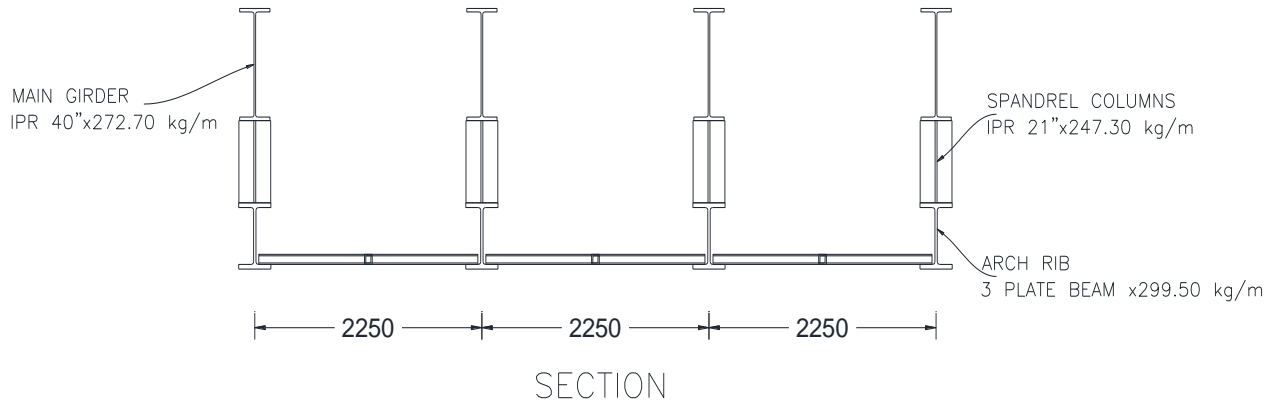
Elevación transversal en la corona del arco, donde este se junta con las columnas que unen al arco y las vigas principales.
